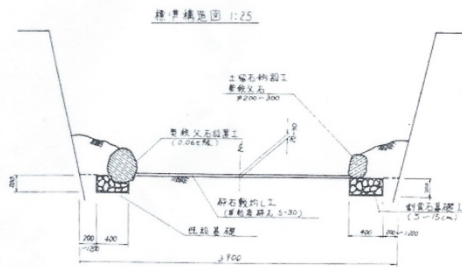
みんなの夢水路事業施工前の水路断面図 (杉並区提供)
